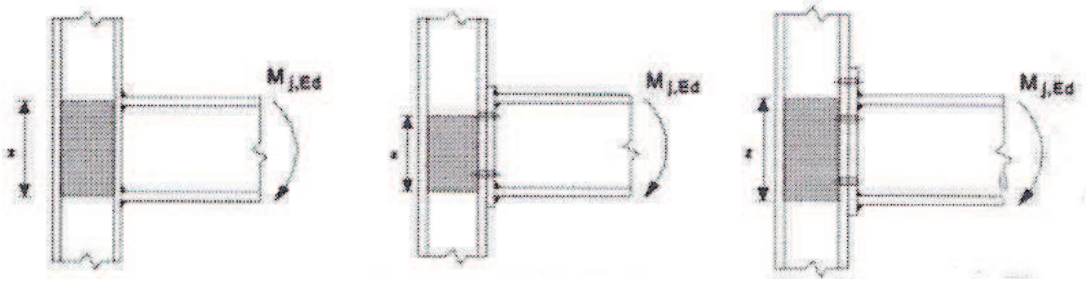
Braço das forças  $z$  para os três tipos de ligação viga-coluna [3]
